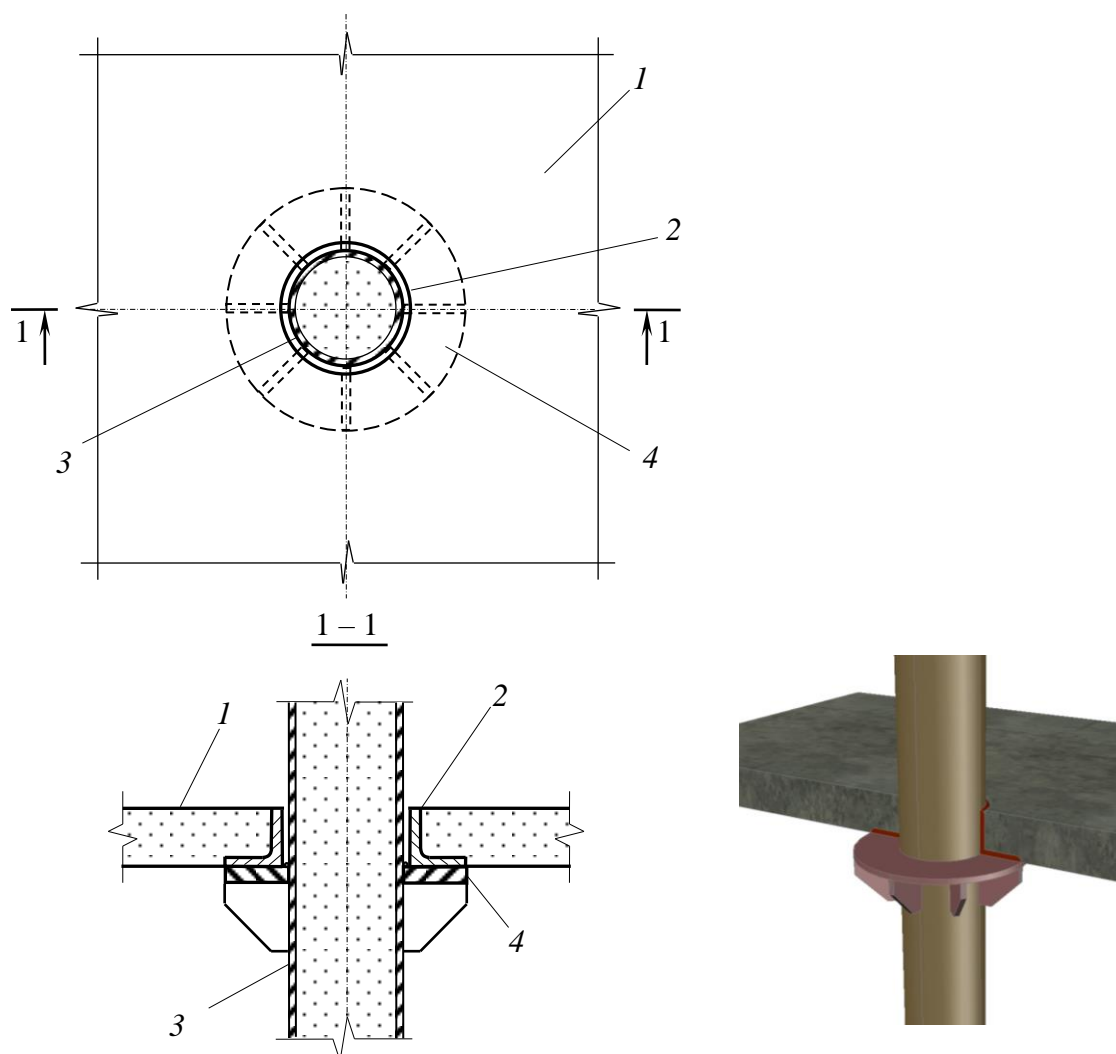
Схема вузла з'єднання надколонної плити сталезалізобетонного безбалкового перекриття з трубобетонною колоною
